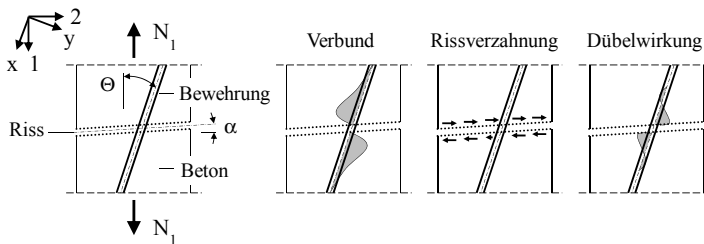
Kraftübertragung im Riss bei Scheiben mit schiefwinkliger Bewehrung
